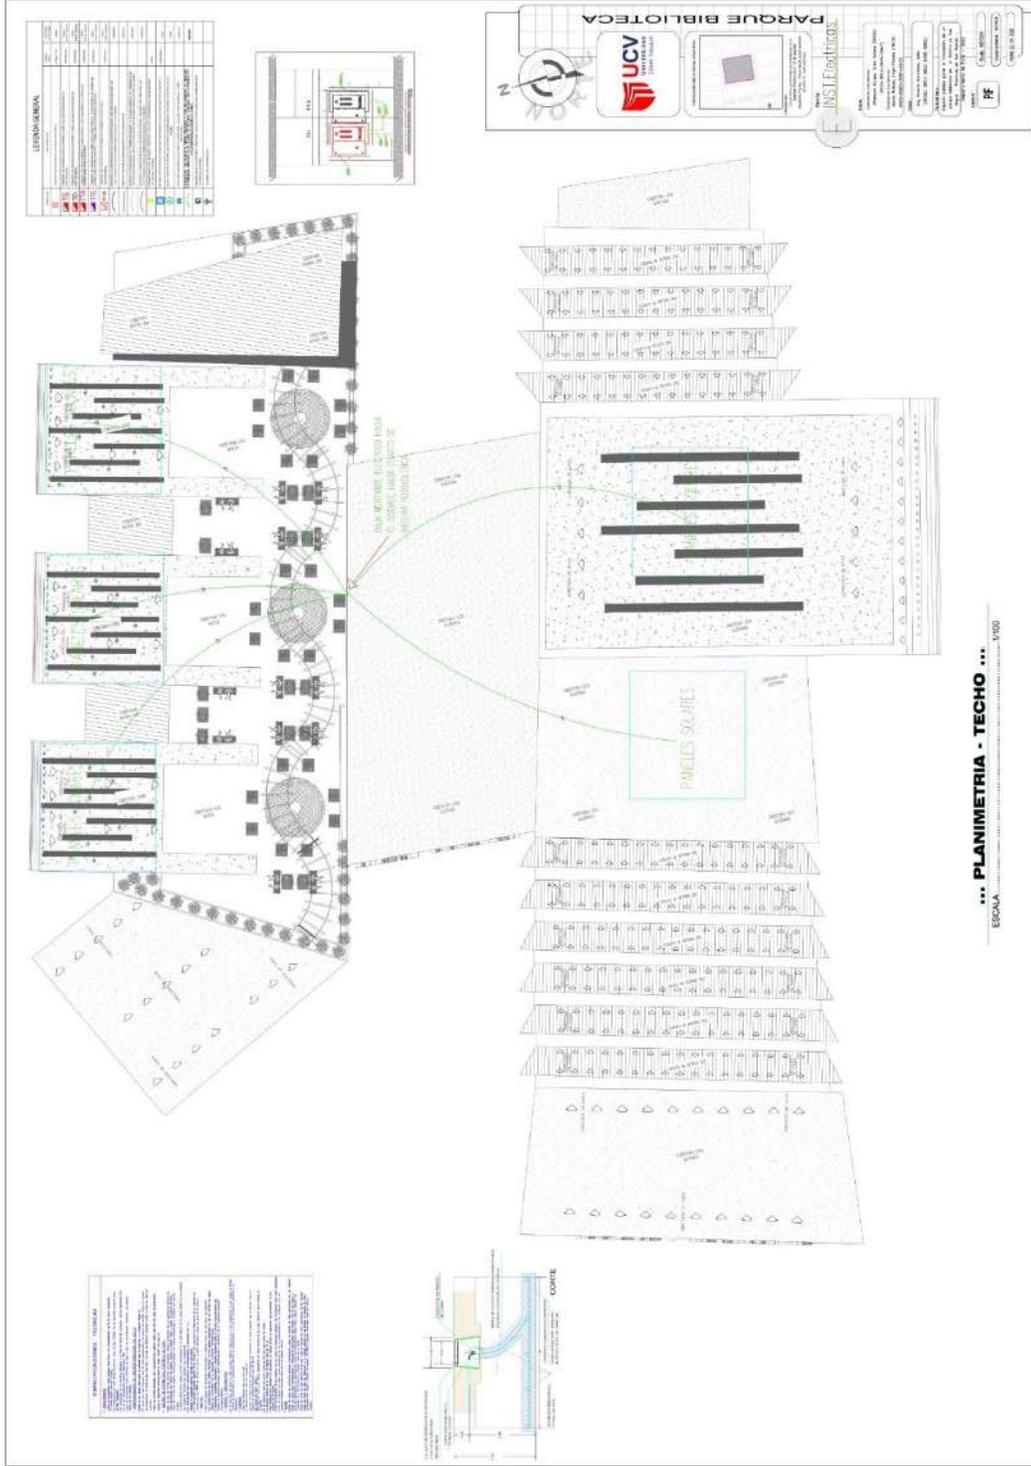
Plano de Instalaciones Eléctricas – Techos.
